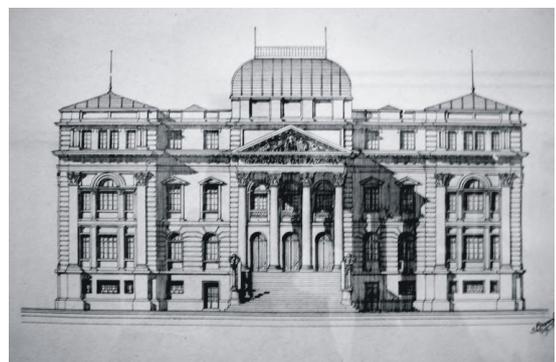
Fachada do edifício voltado para a Av. Mauá.
